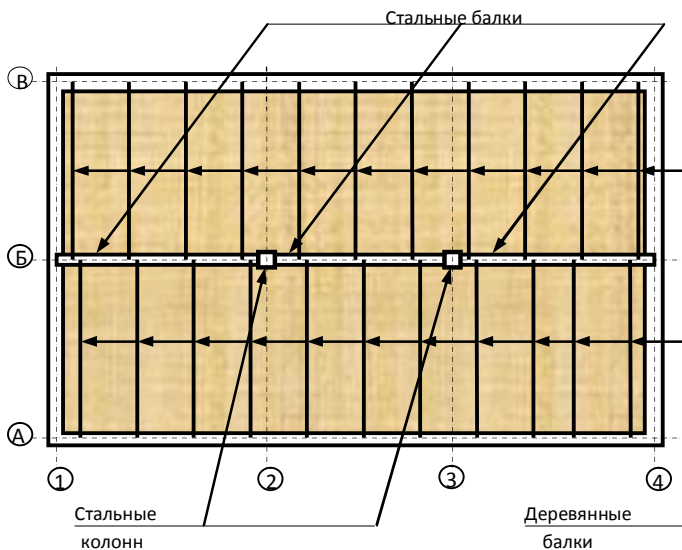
Схема раскладки элементов перекрытия по стальным и деревянным балкам
